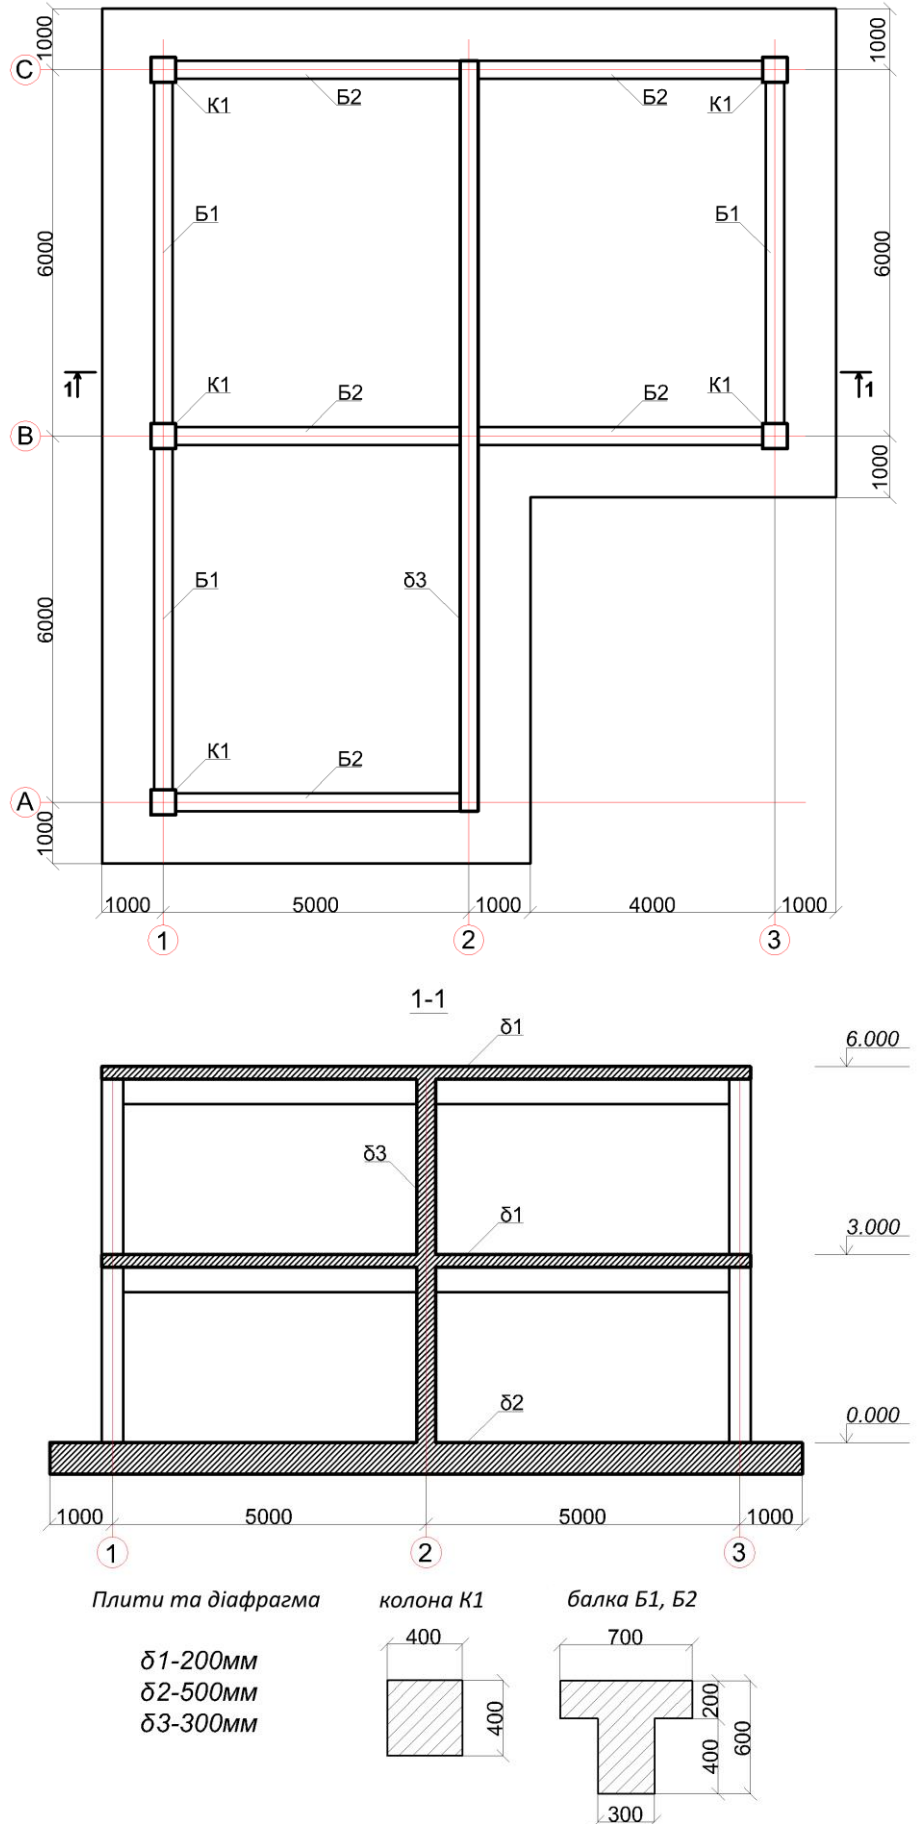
Схема каркаса і перерізу елементів каркаса будівлі
